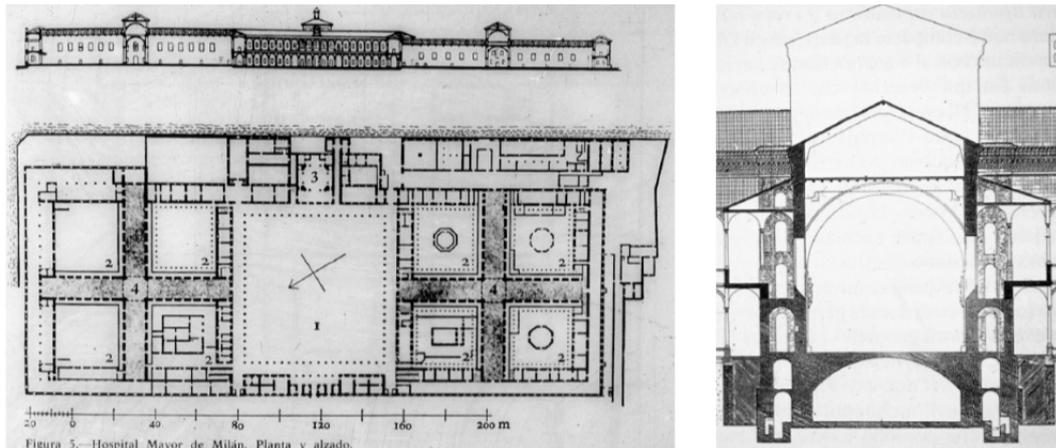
Hospital Mayor de Milán. Planta y alzado.
